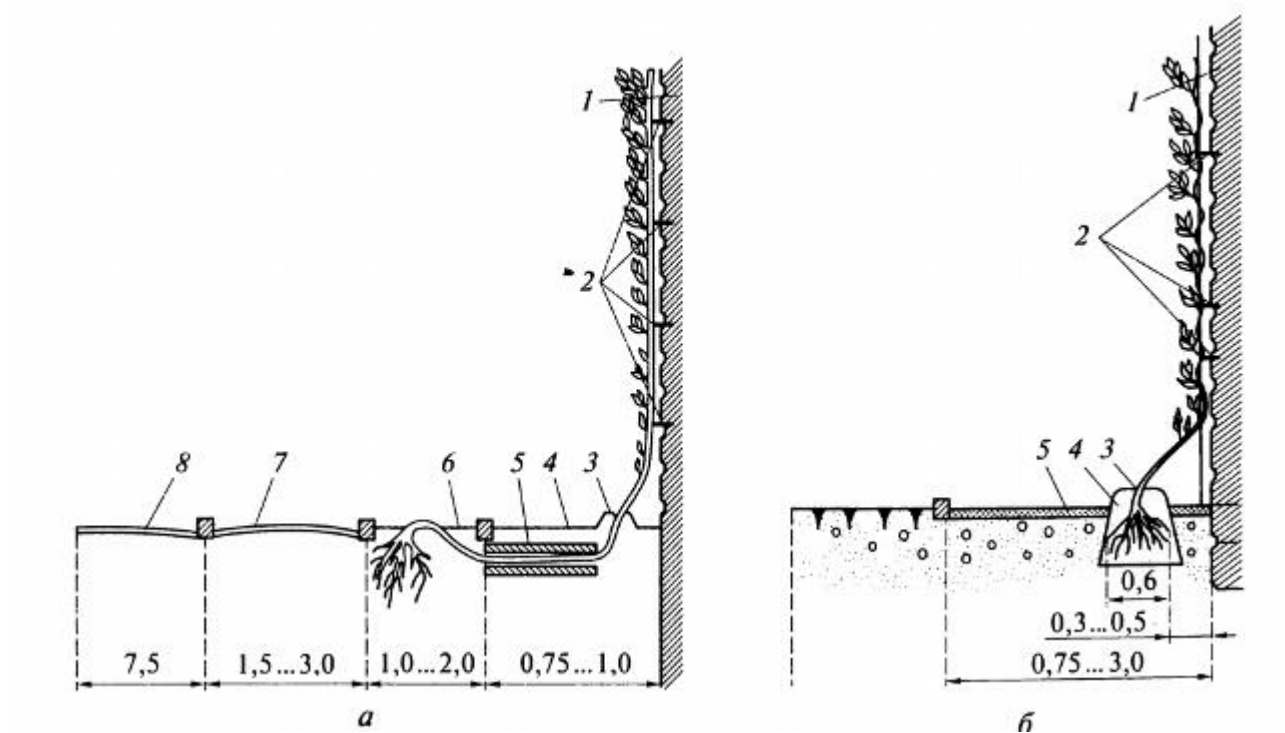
Схеми розміщення і посадки ліан у стін будівель (розміри вказані в м):
